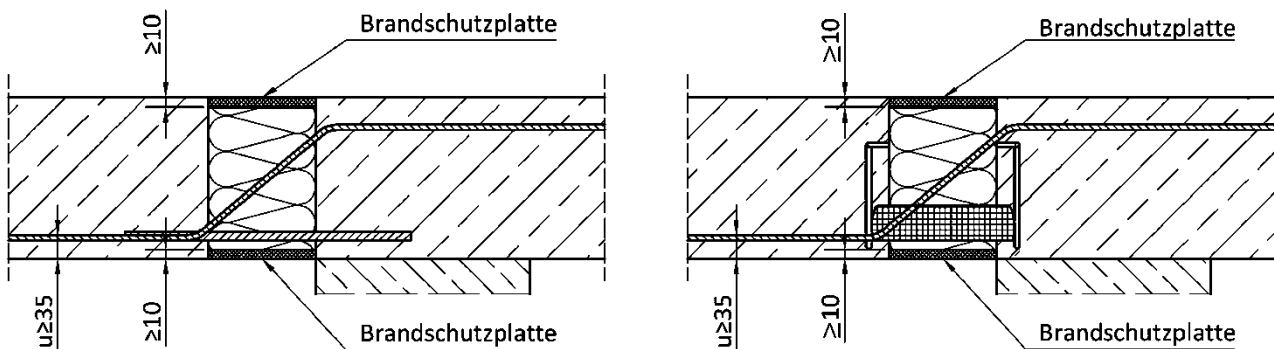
Ausführung ISOPRO mit SCB (links), mit HPCB (rechts), exemplarisch Typ IP Q
